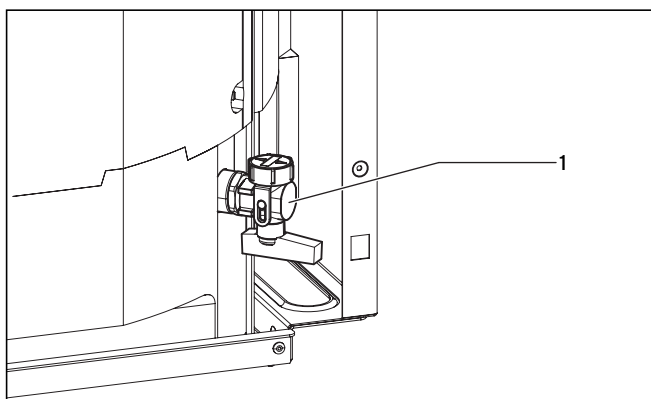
Svuotamento della caldaia lato acqua calda
